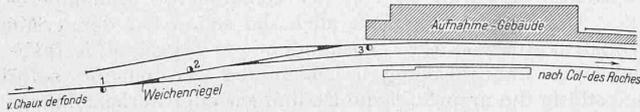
Lageplan des Bahnhofs Locle. — Masstab 1 : 3000
